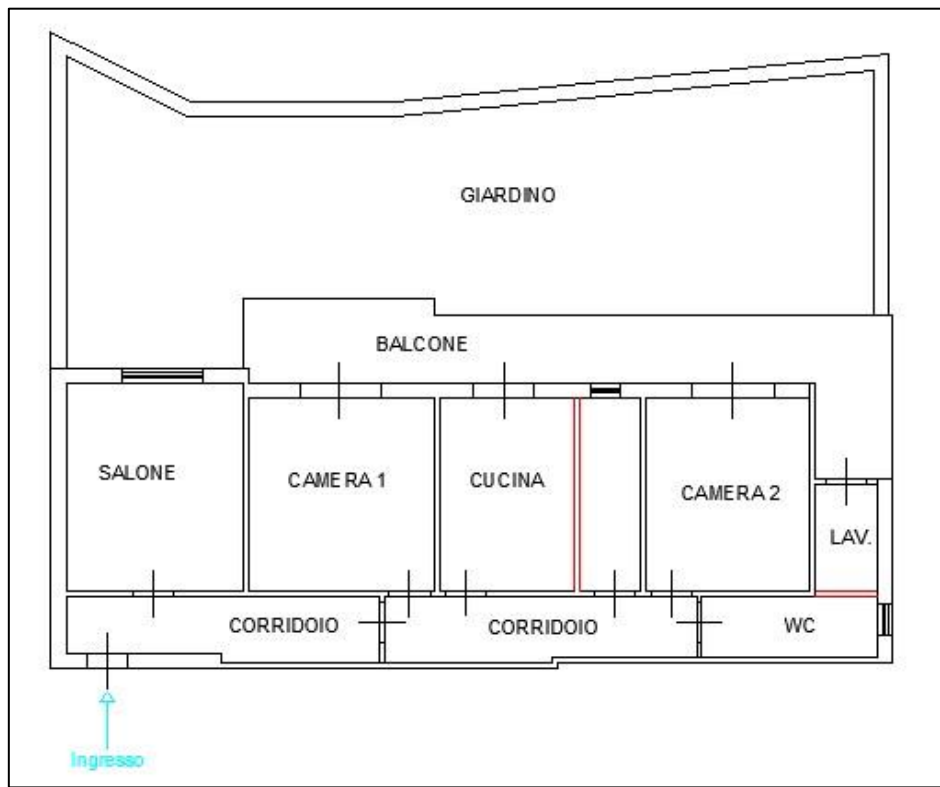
Planimetria allo stato di fatto – modifiche evidenziate in rosso
